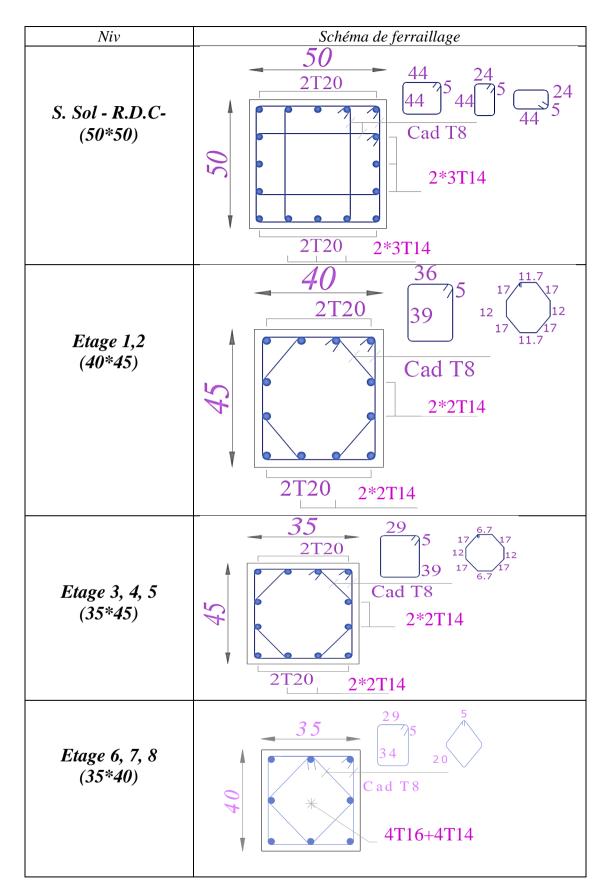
Ferraillage des poteaux (Vue en plan)
